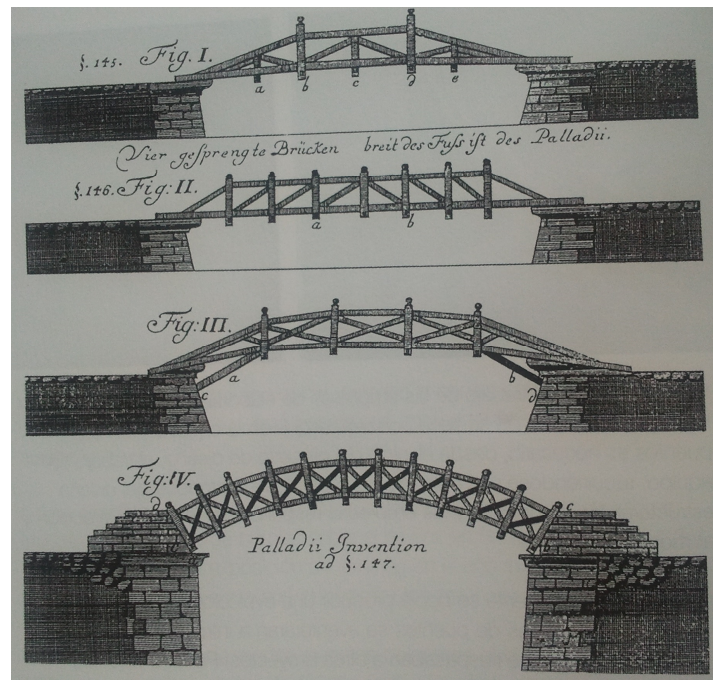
Sistemas Estruturais de Pontes - Andrea Palladio (Schwaner, 2004)
